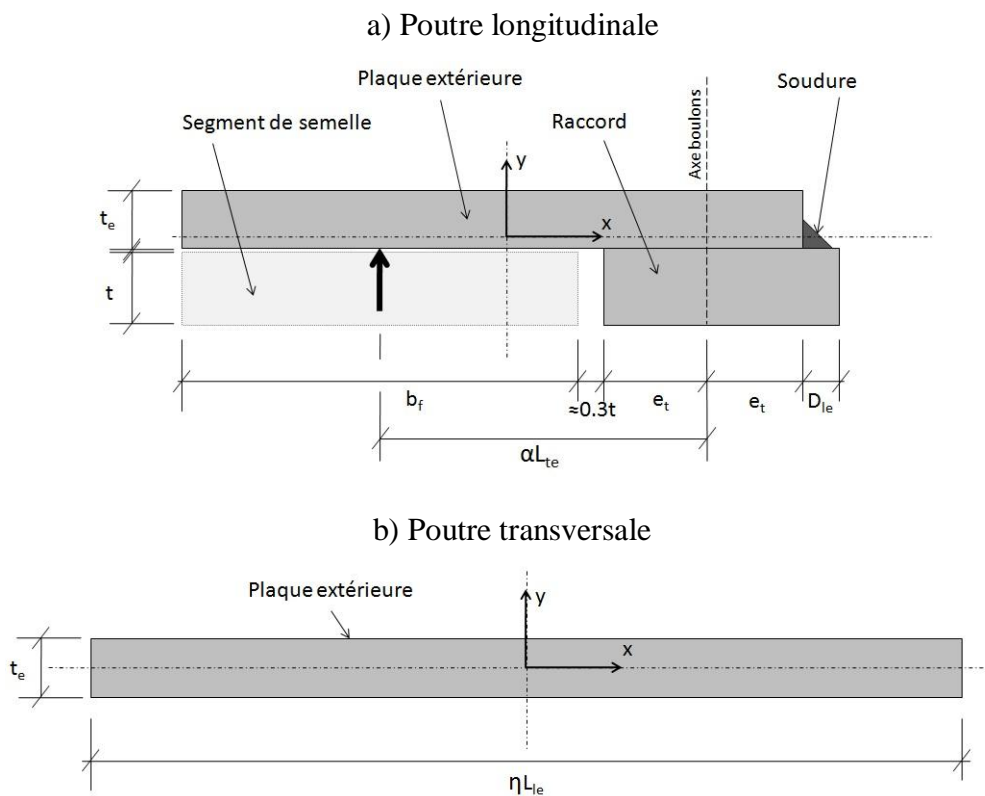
Sections du système de poutre associé à la plaque extérieure
